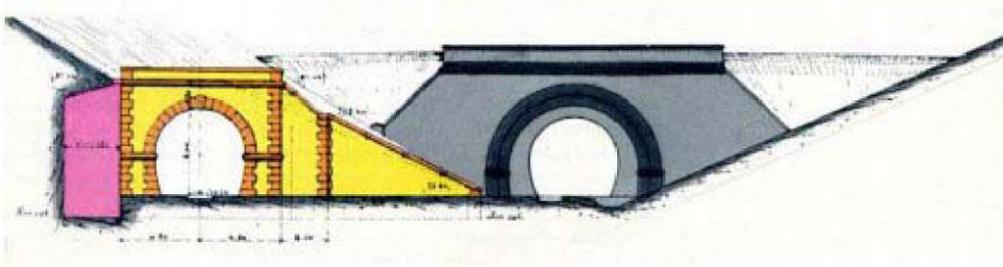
Photocopie extraite du plan de « construction d'un second tunnel entre Statte et Huy pour la voie directe », dressé à Paris le 9-3-1905 ; élévation de la tête vers Liège.
